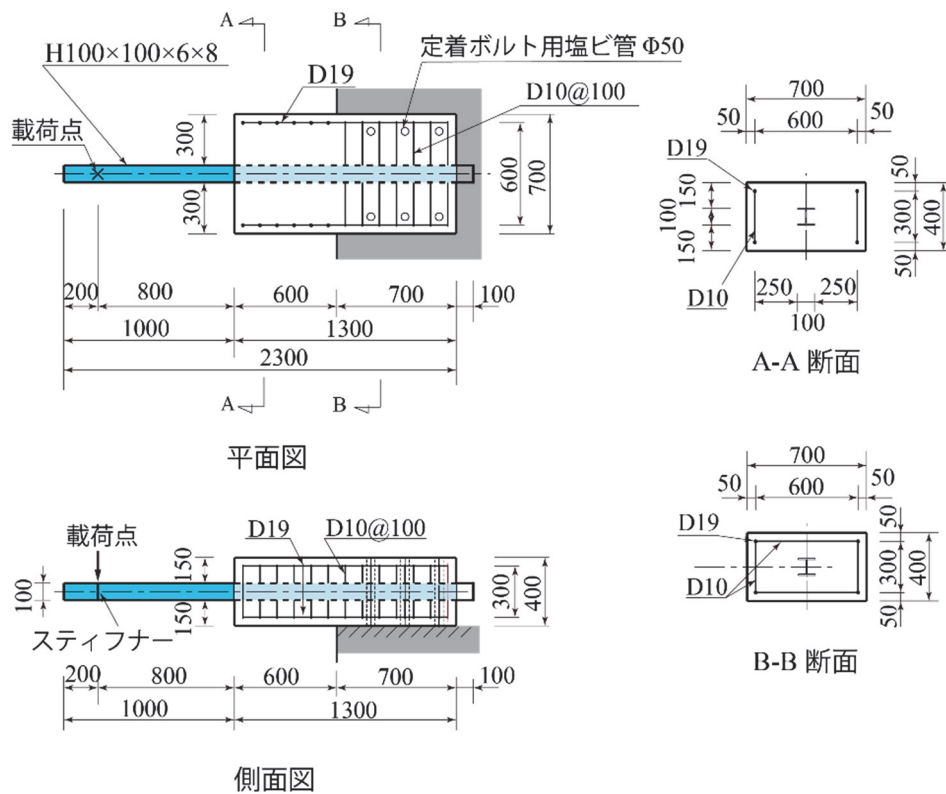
試験体の断面寸法，支柱模型の設置位置，鉄筋の配筋状況
